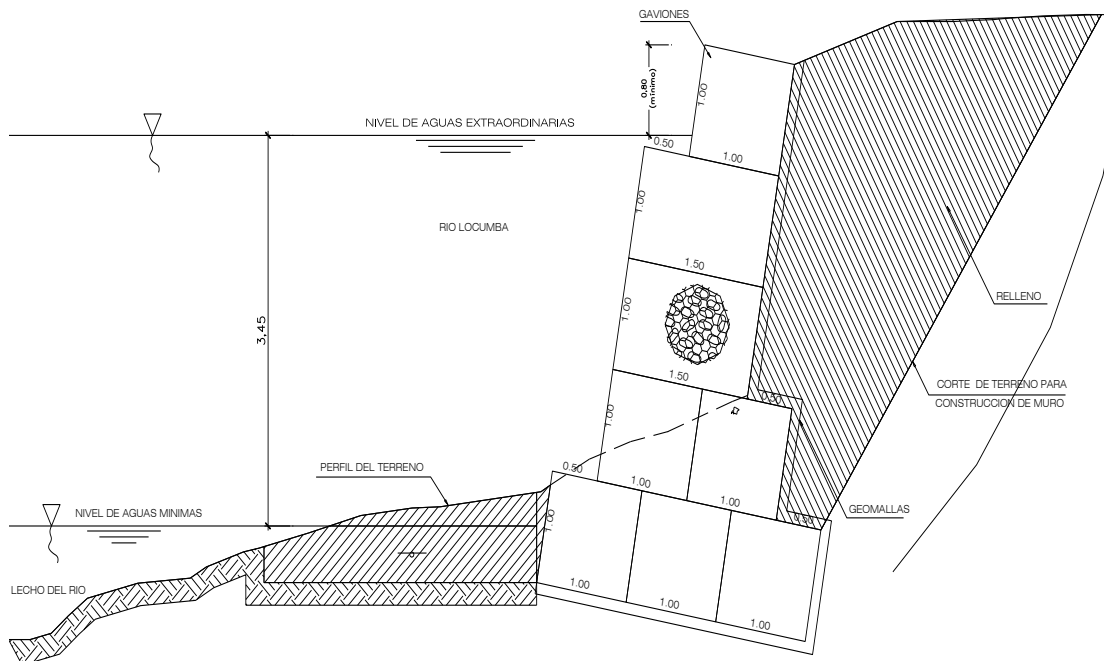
sección típica de muro gavión MG-2, donde se tiene una altura de 5 m. con una base de 3 m. utilizado para dar protección a las zona de proyecto 1 (Carretera asfaltada en servicio C.P. Mirave – Oconchay y caseta de control).
